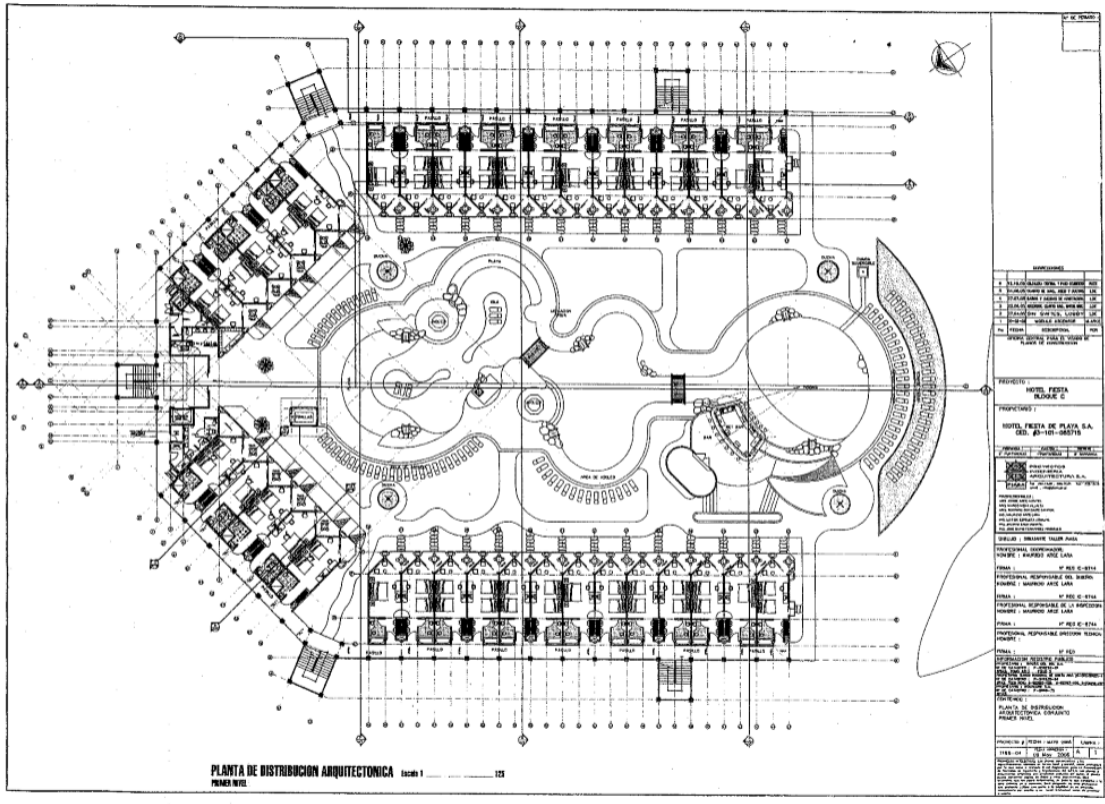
Escáner de plano original del primer nivel, edificio C. Fuente: (Hotel Fiesta Resort, Gerencia)
